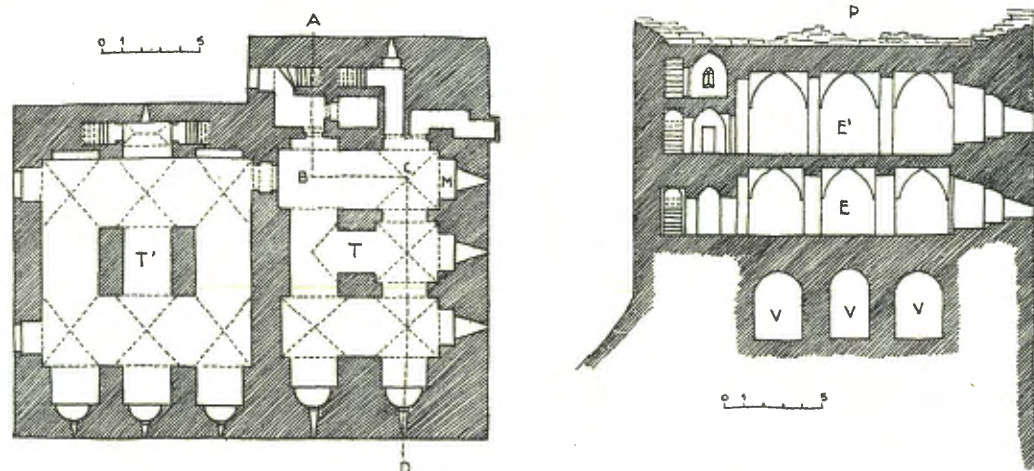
Plan du donjon D à l'étage E' (fig. 107). Fig. 107. — Coupe sur A B C D du plan (fig. 106).
